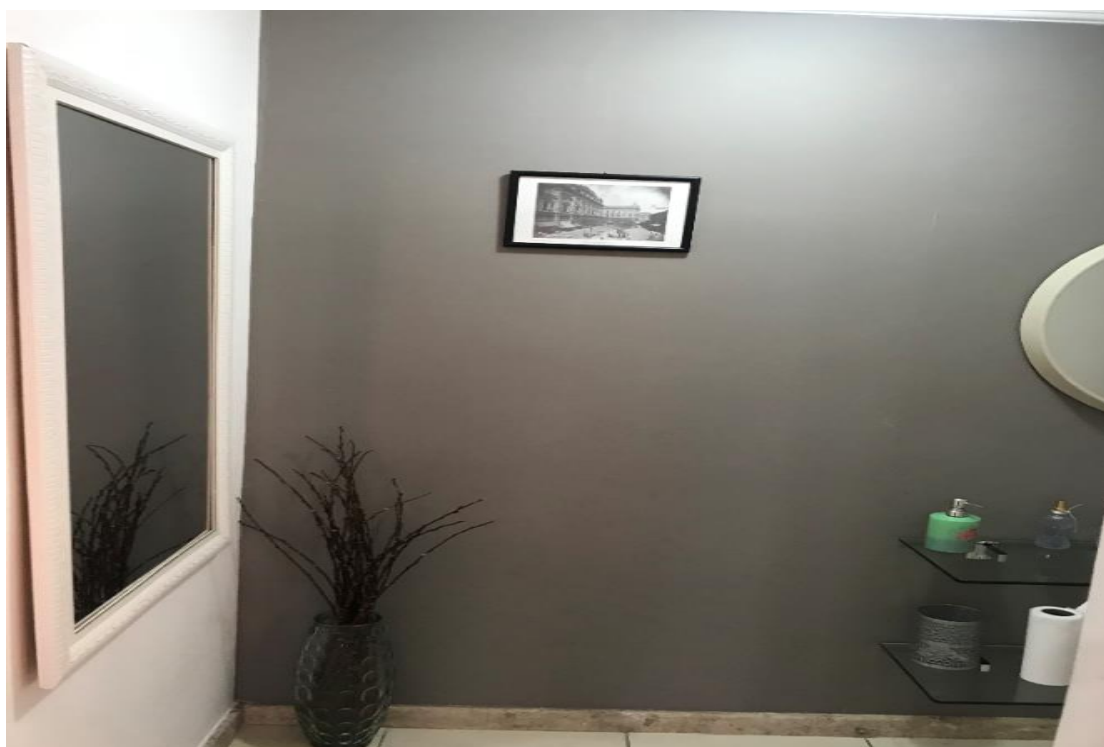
Acesso ao lavabo – Pavimento térreo
